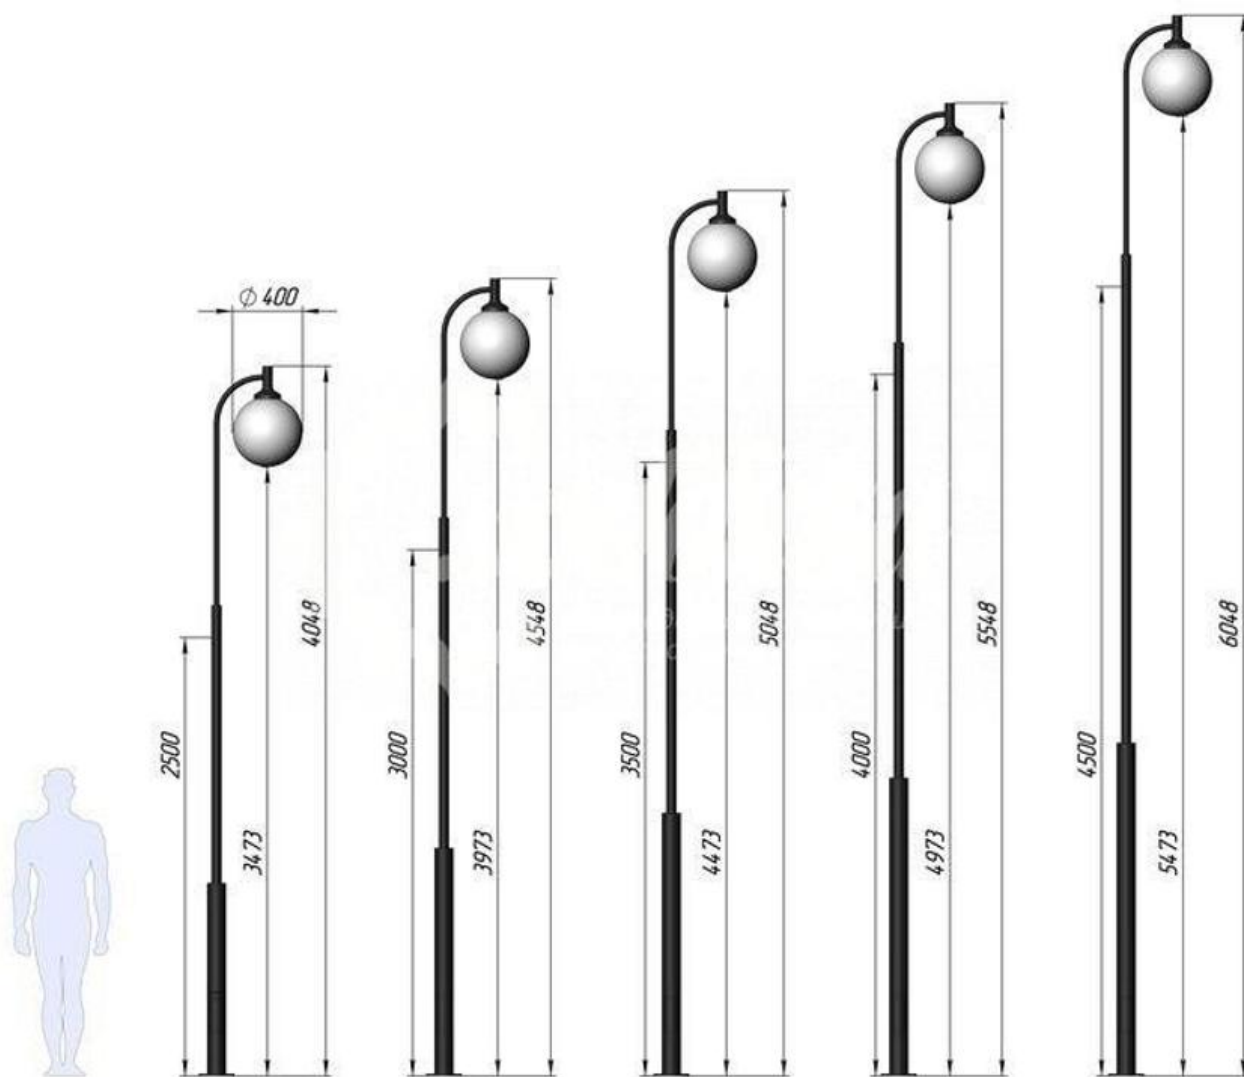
Загальний вигляд та конструкційні розміри опор освітлення
